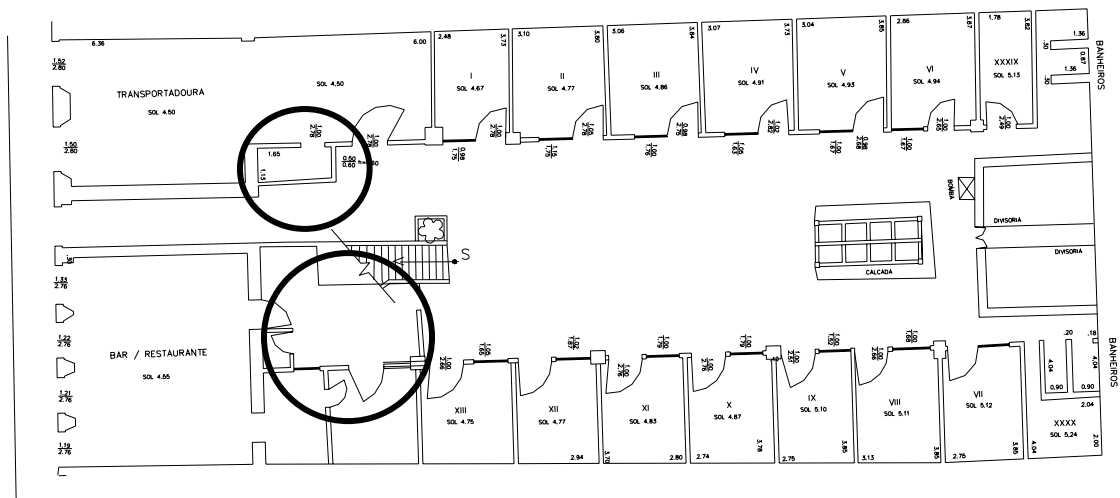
Planta baixa do primeiro pavimento, antes da intervenção. Em destaque os dois acréscimos (SDL, 1995, p. 1.).
